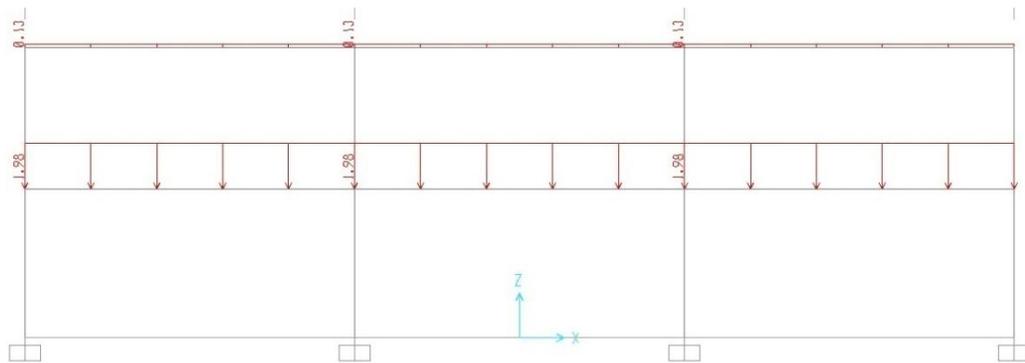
Cargas aplicadas a las vigas de un pórtico.
